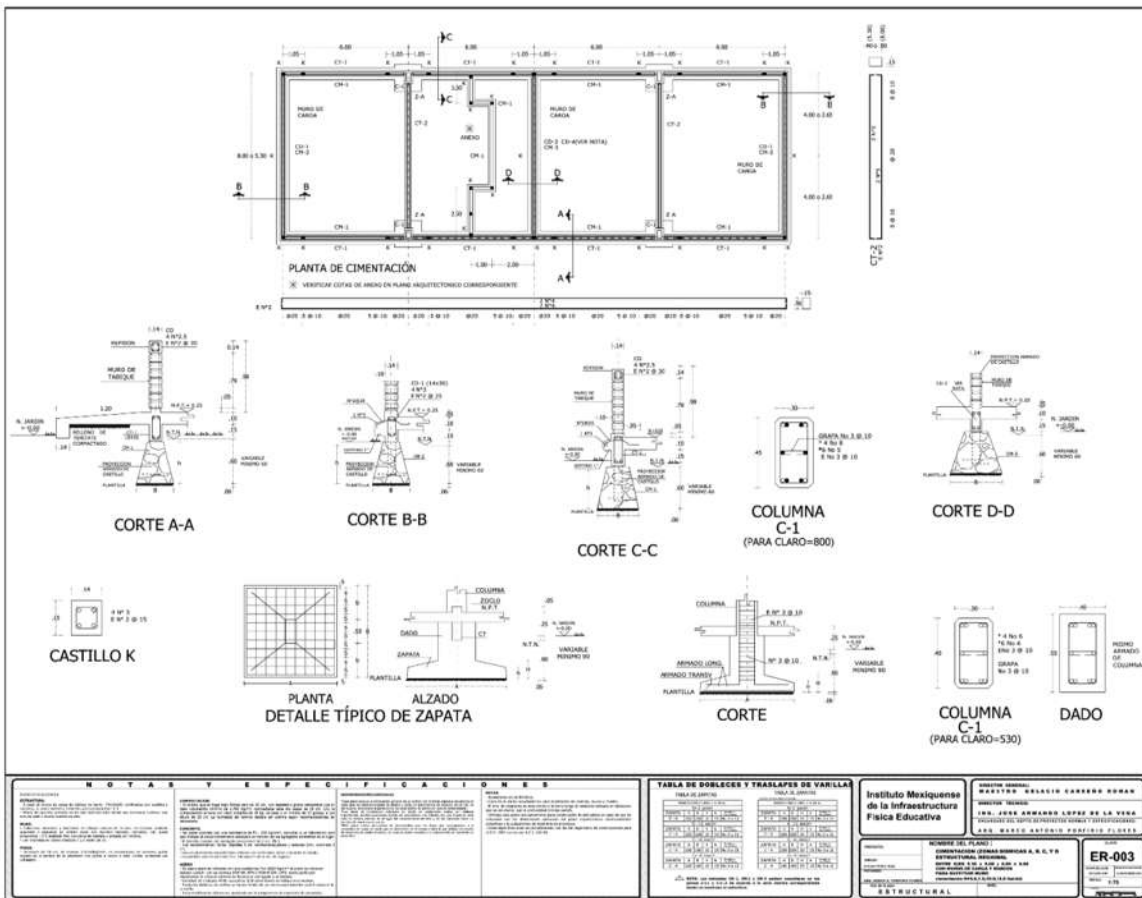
Plano de armado de zapatas, castillos, columnas y contra traves.
